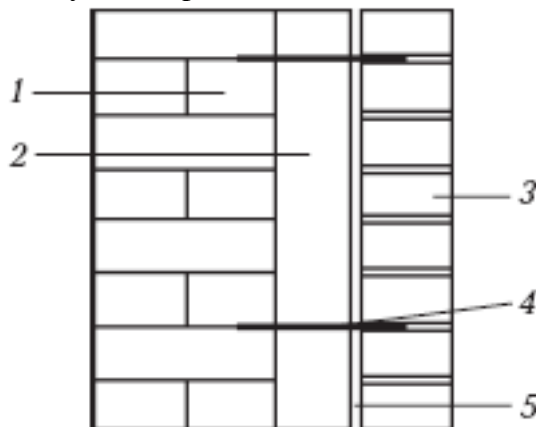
Устройство слоистой кладки: 1 – несущая стена, 2 – теплоизоляция, 3 – облицовочный слой, 4 – закладные детали (связи), 5 – воздушный зазор
